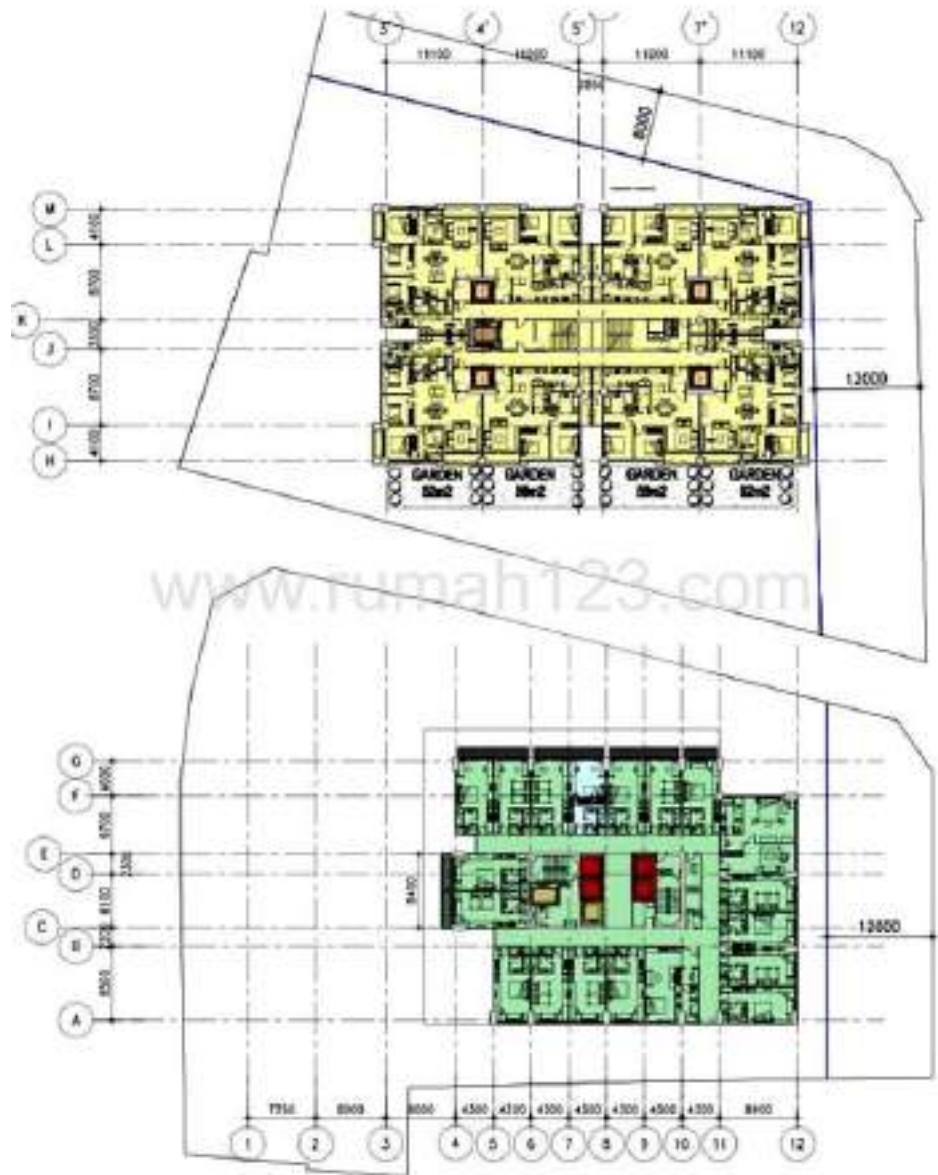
Alur sirkulasi eksisting bangunan Hotel dan Apartemen Tentrem Semarang
